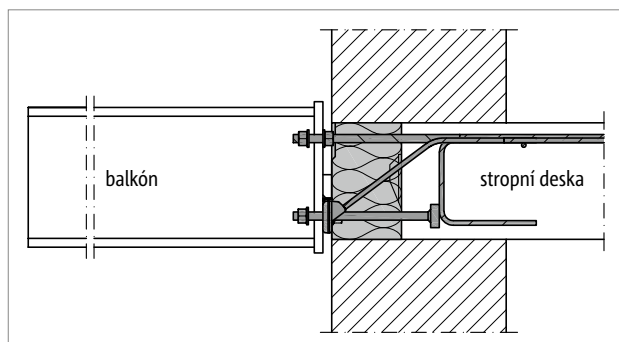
Schöck Isokorb® XT typ SKP-WU-M1: Atypická konstrukce pro kotvení do stěny
